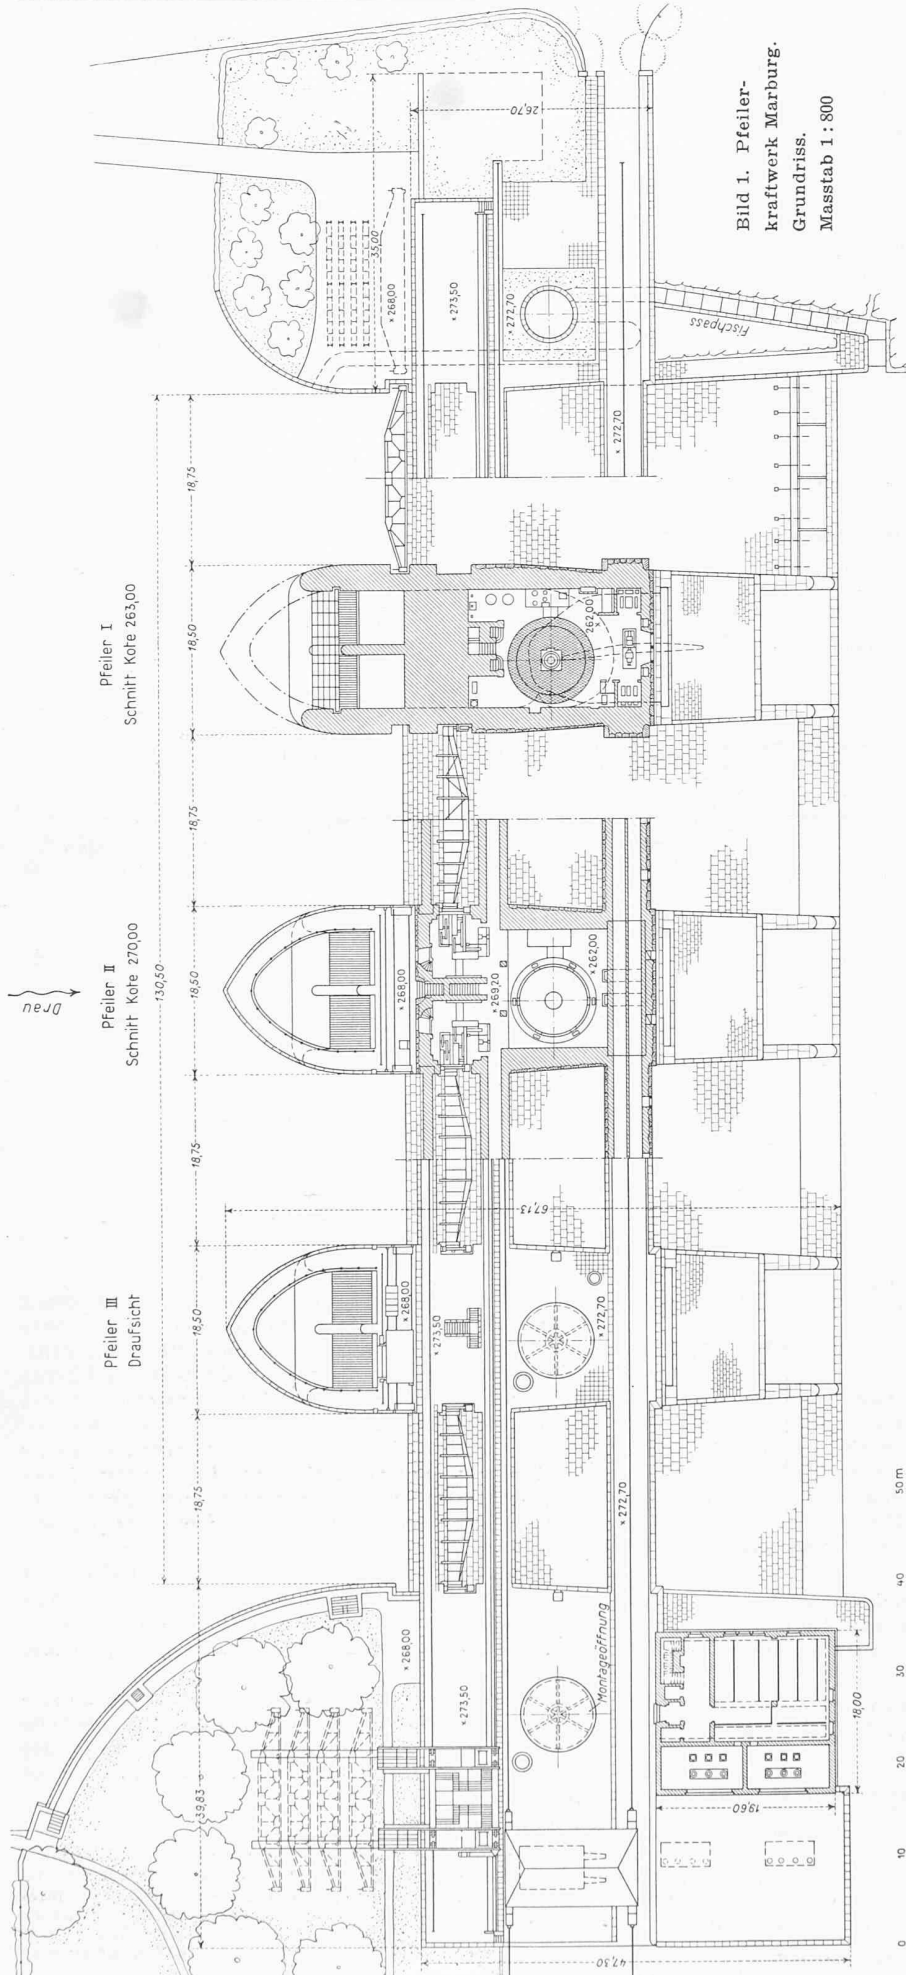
Pfeilerkraftwerk Marburg. Grundriss. Masstab 1 : 800
